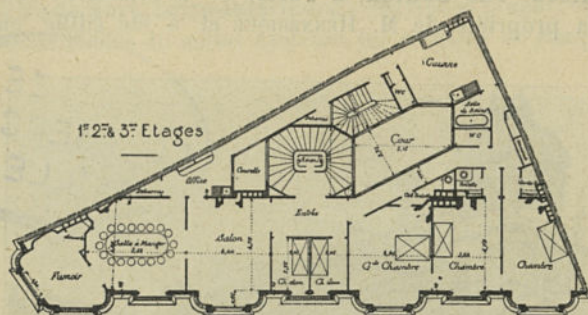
Maison, rue Danton, à Paris. Plan.
